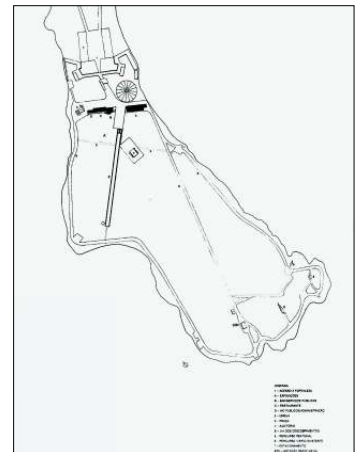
/XXI- Idem, Planta Geral da Intervenção.
